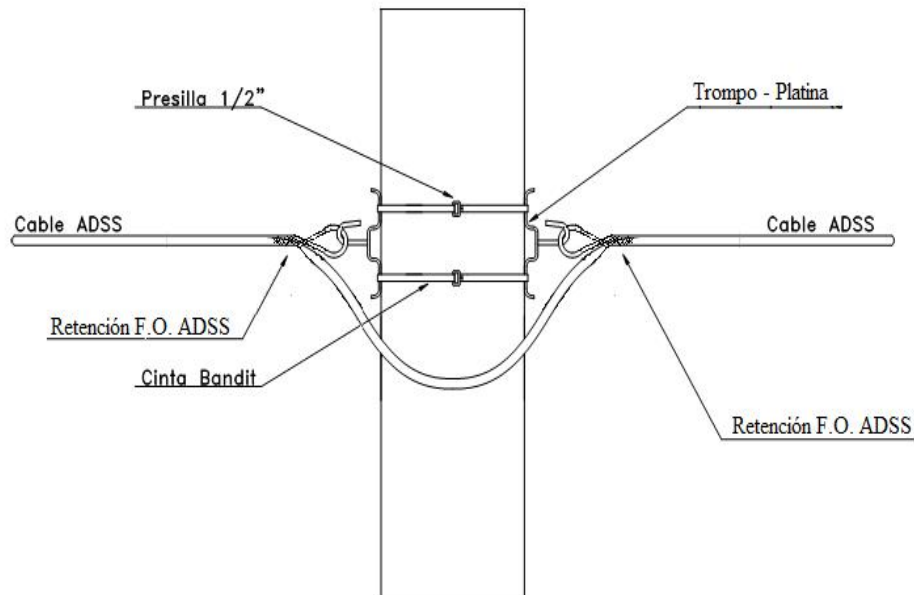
INSTALACIÓN DE FERRETERÍA DE ANCLAJE
